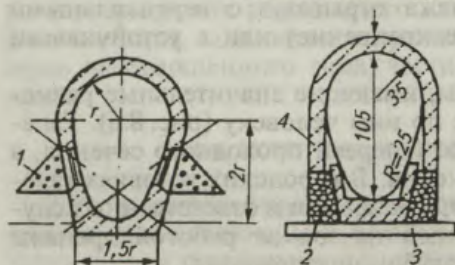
Железобетонные галереи овоидальной формы (размеры в см):
